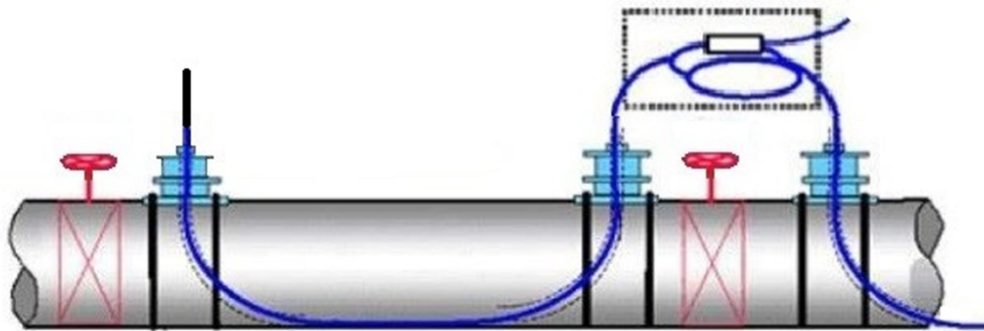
Secțiune transversală ce prezintă FO instalată într-un sistem de apă potabilă
